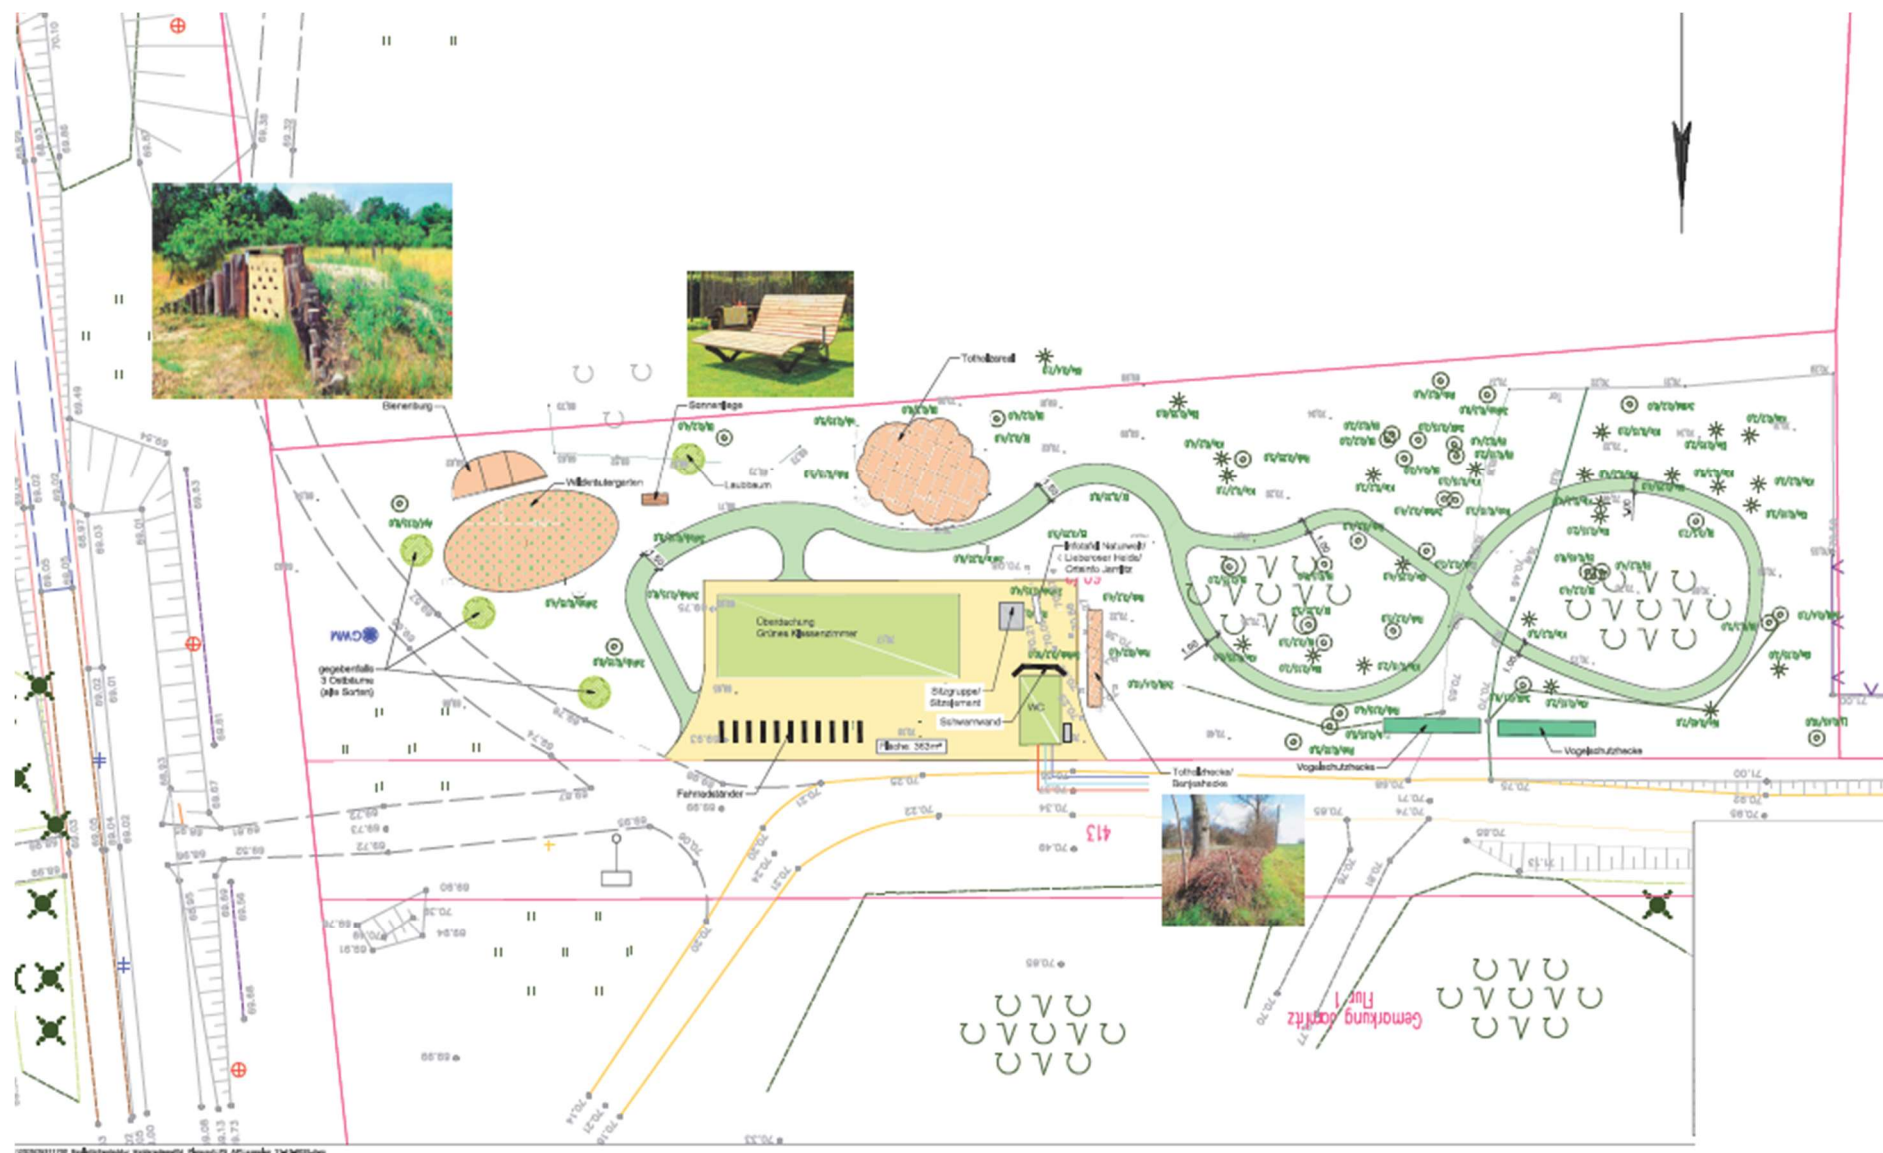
Lageplan Fahrradrastplatz "Grünes Klassenzimmer"
